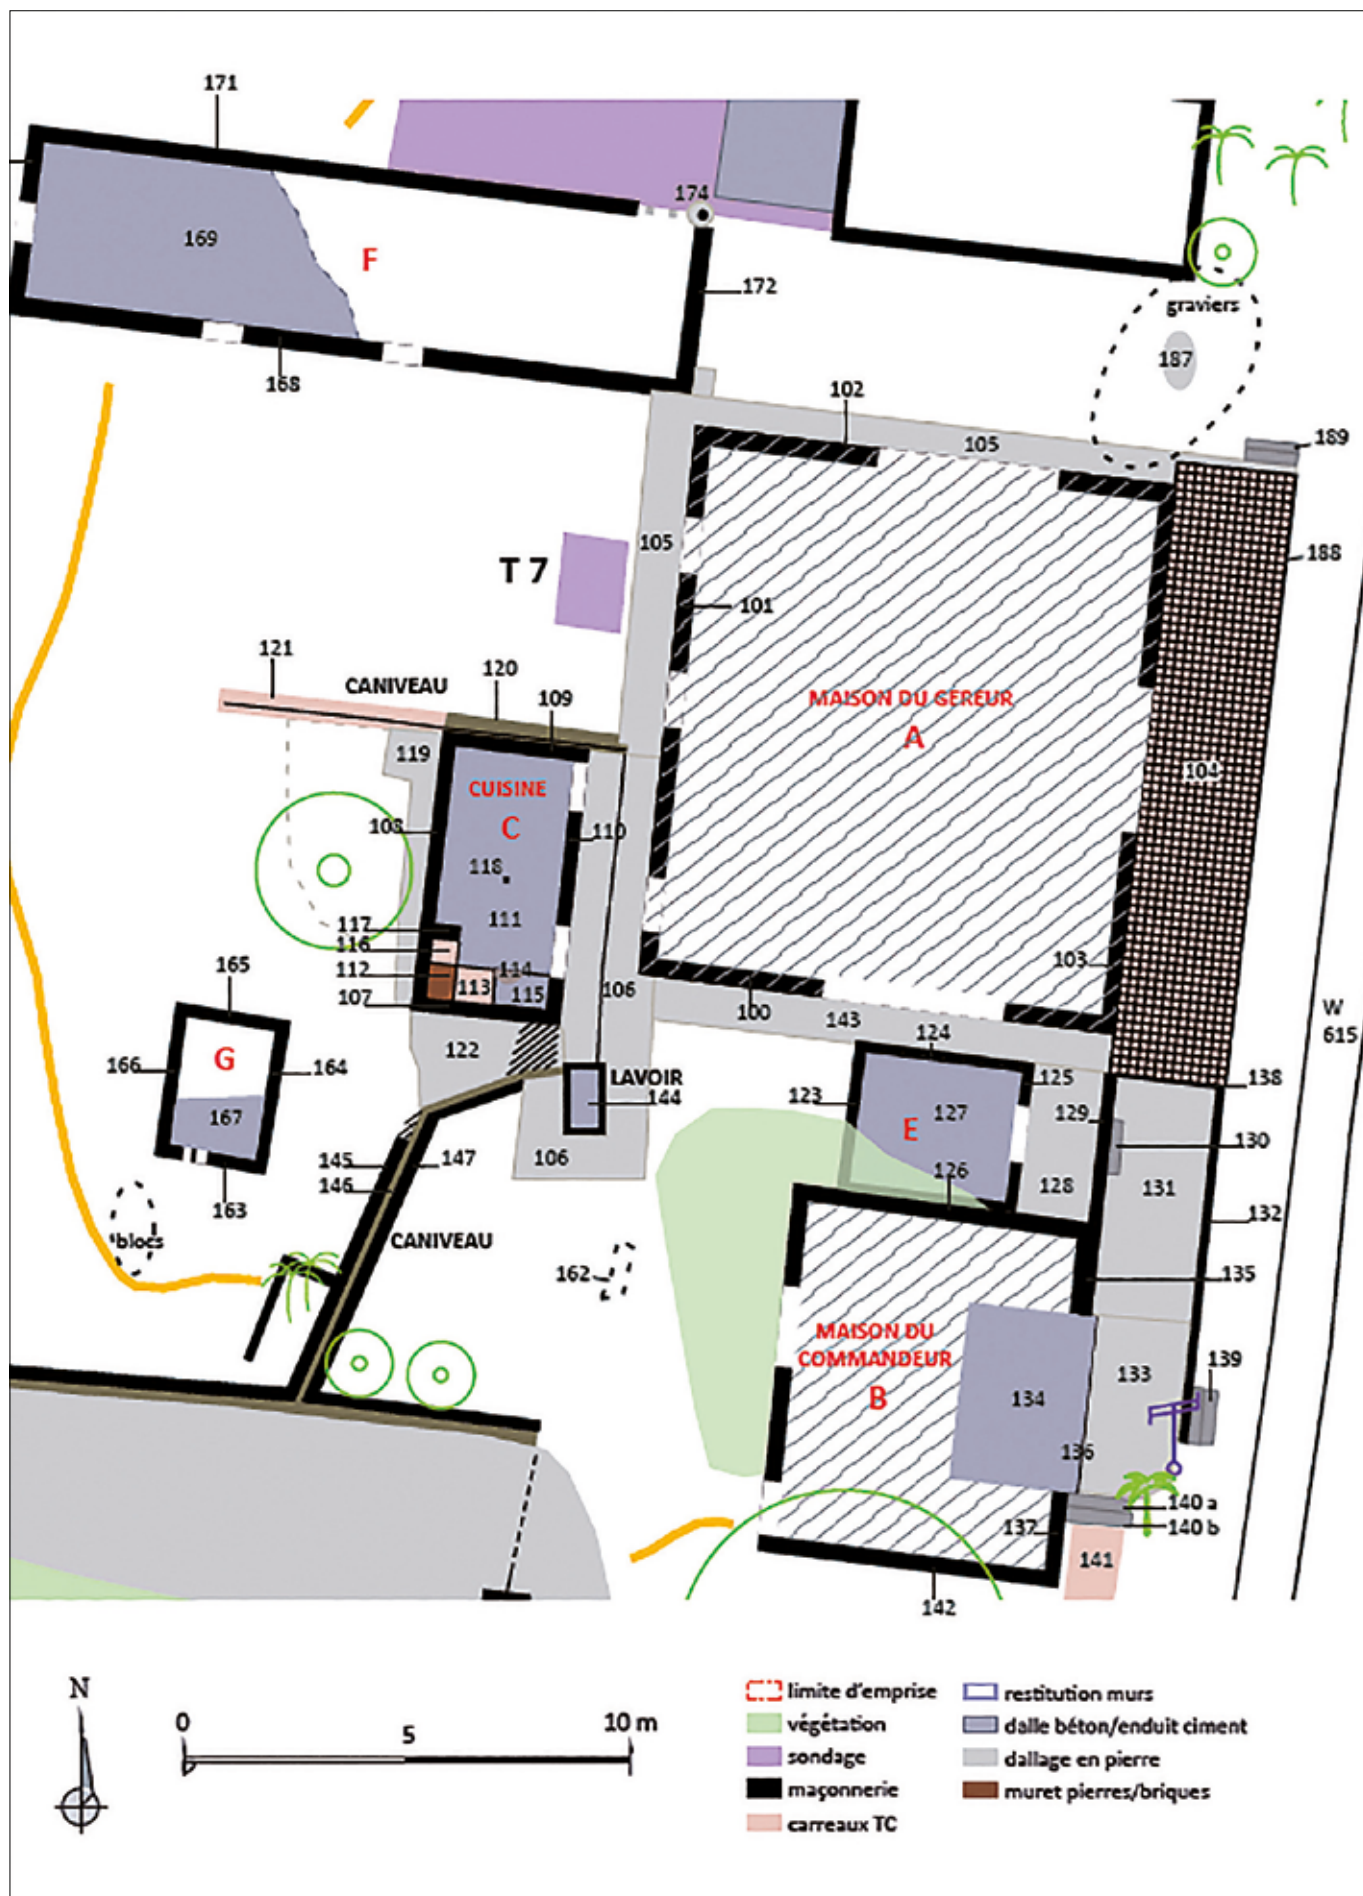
Plan des bâtiments A, B, C, E et G, © P.-Y. Devillers, S. Delpéch (INRAP).
